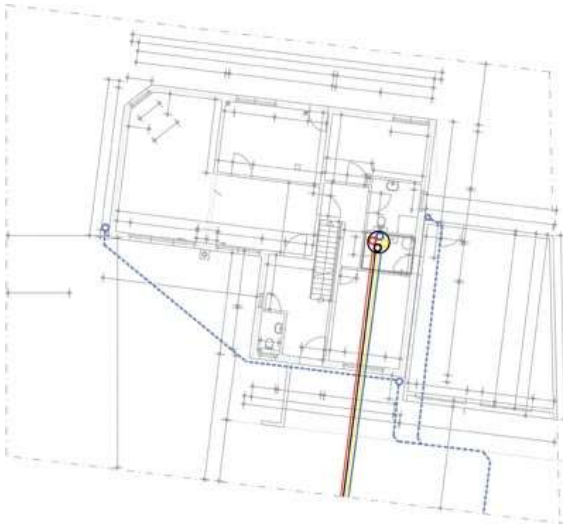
Ausführungsplan mit Mehrspartenhauseinführung
